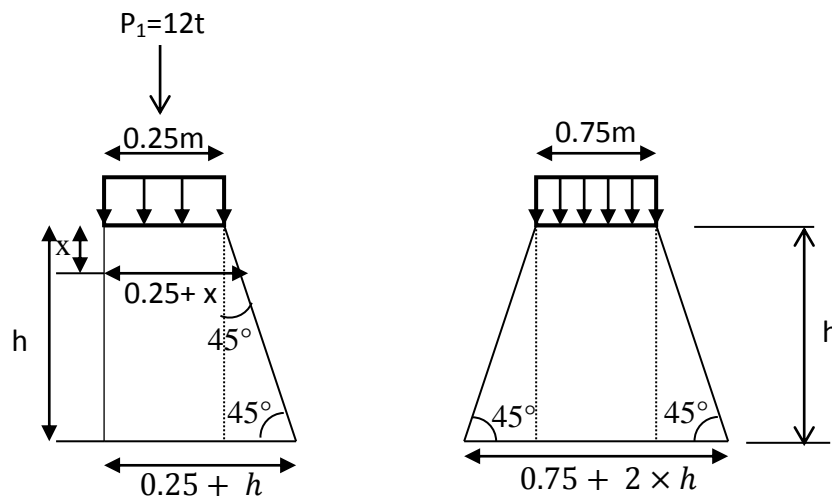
Poussée de la charge locale située en arrière du mur.
